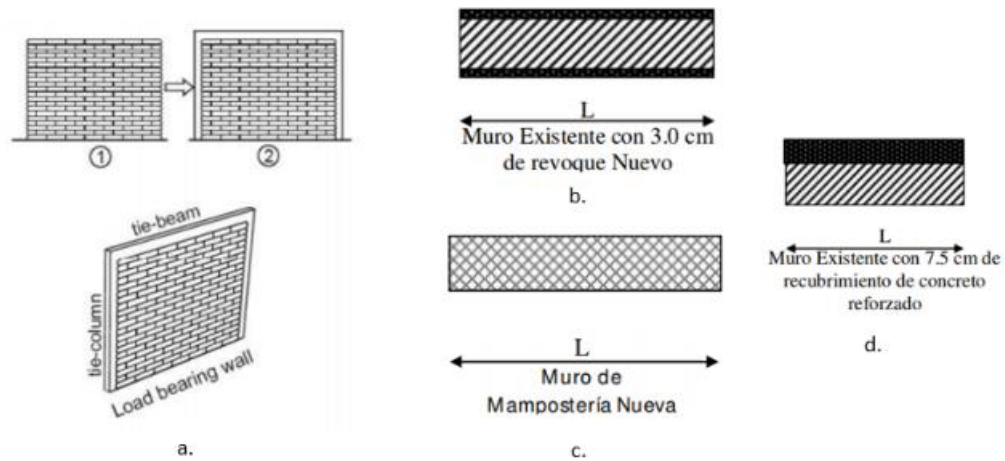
Técnicas de reforzamiento propuestas en el Manual: a) Confinamiento con elementos de concreto; b) Revoque en dos caras de muro existente; c) Muro de mampostería nueva; d) Recubrimiento de concreto reforzado en una cara (BuildChange, 2015).
